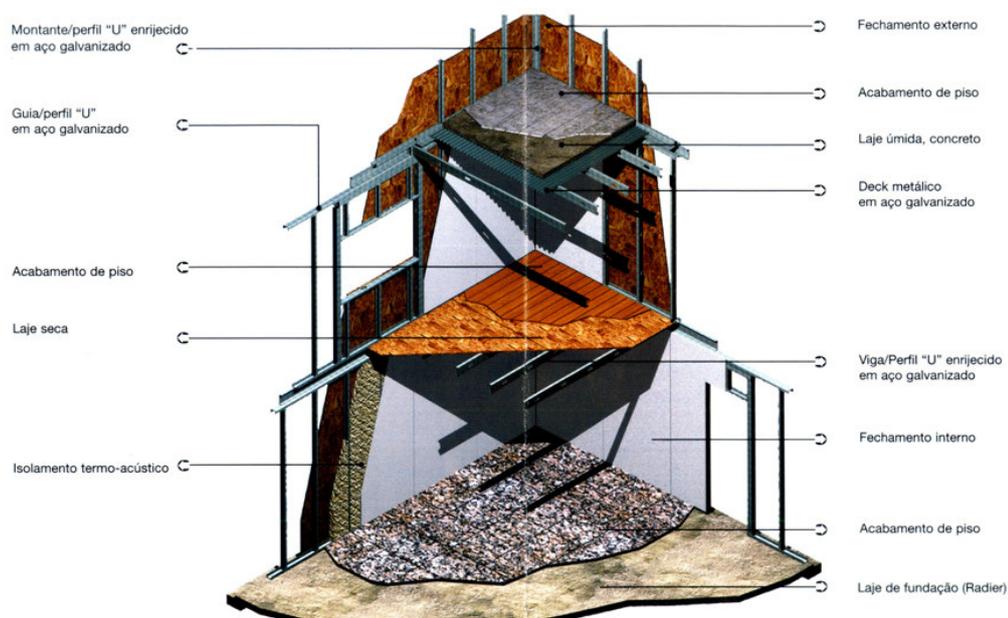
Alguns dos subsistemas do *Light Steel Framing
